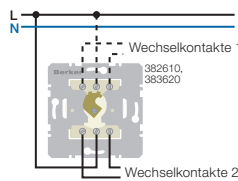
Wechselschalter 1- und 2-polig für Schließzylinder [Best.-Nr. 3826 10, 3836 20]
